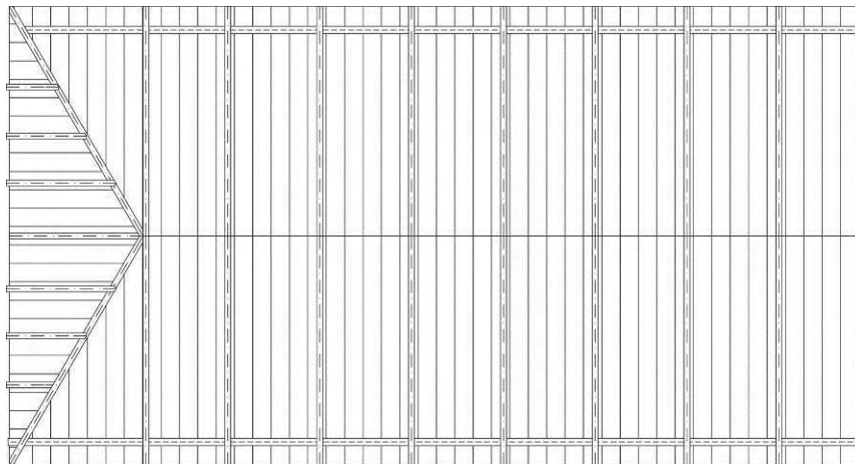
Sparrenplan Dachfläche Haupttrakt
